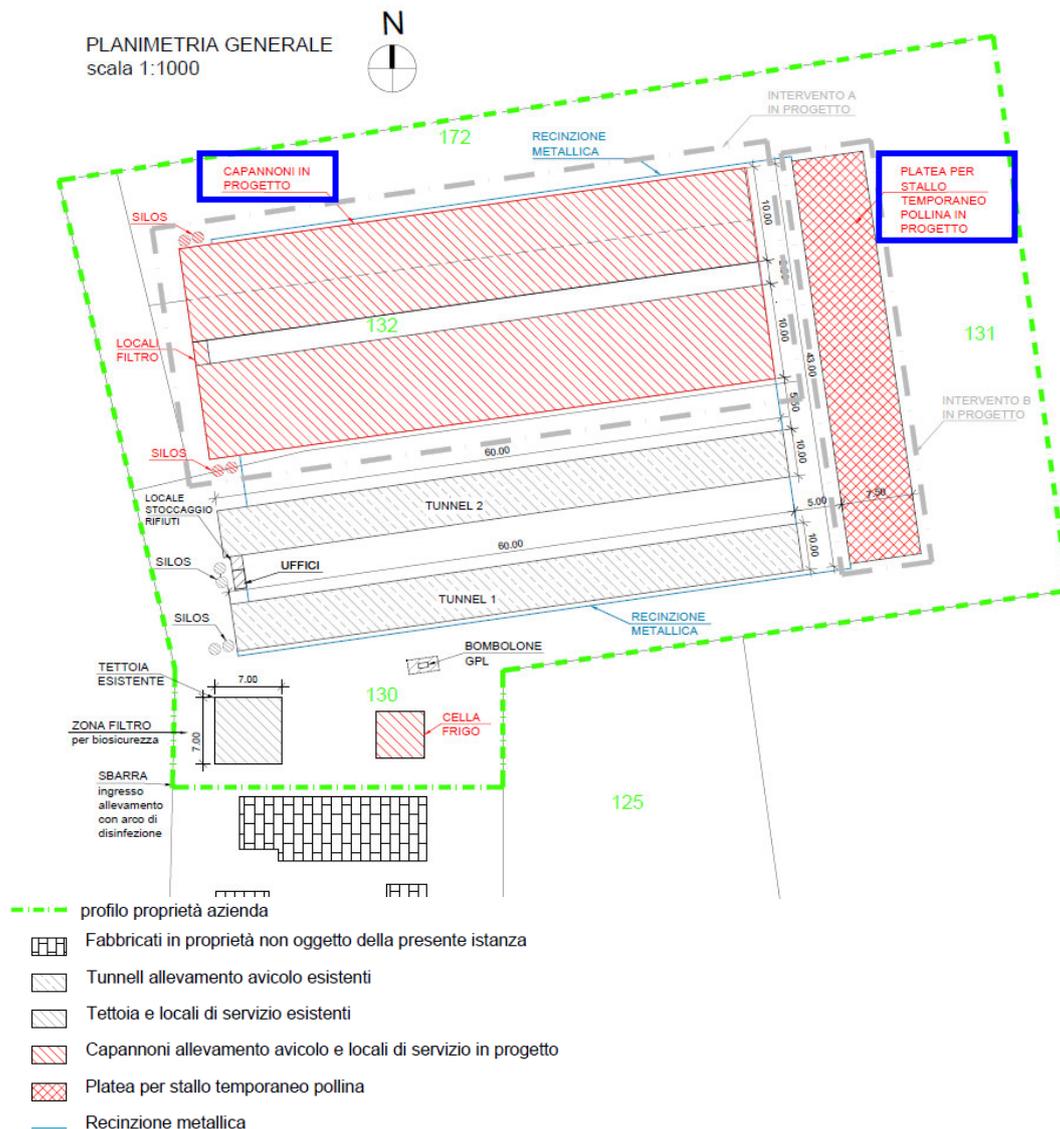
Planimetria generale dell'area in studio con sovrapposizione di quanto in progetto (estratto dalla Tav. 01 dello Studio Tecnico Audero Dott. Geom. Giuseppe - non in scala)
